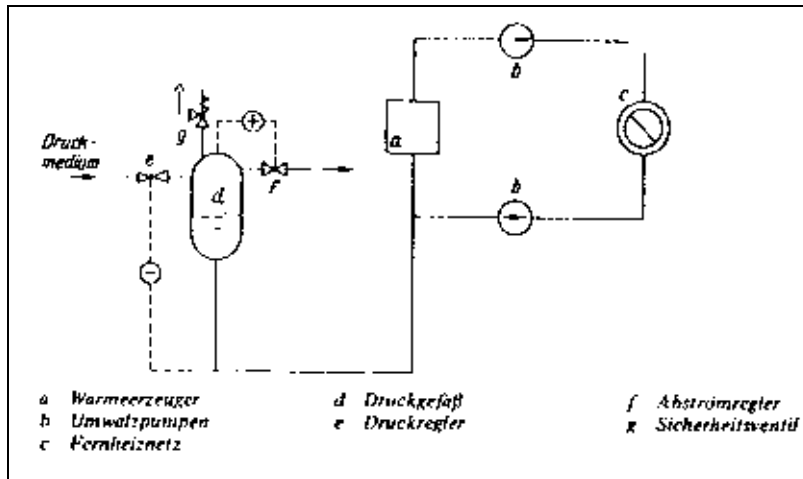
Gasbelastete Druckhaltung mit "konstantem" Ruhedruck
